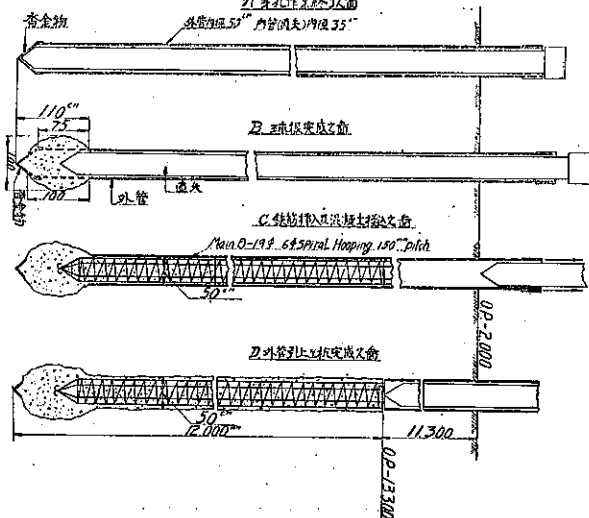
大阪驛構内地下鉄潜函基礎杭施工図
